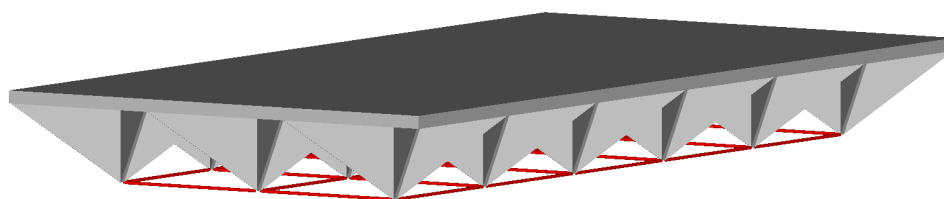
Структурная железобетонная плита покрытия размером 3 на 6 м
